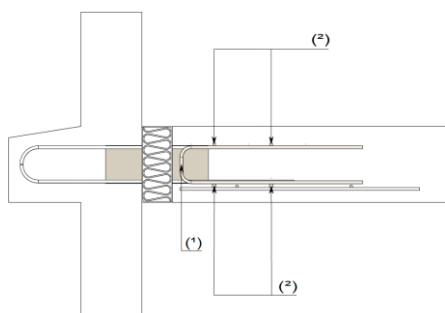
Disposition de chaînage en rive de plancher - liaison dalle-casquette (vue en coupe)
